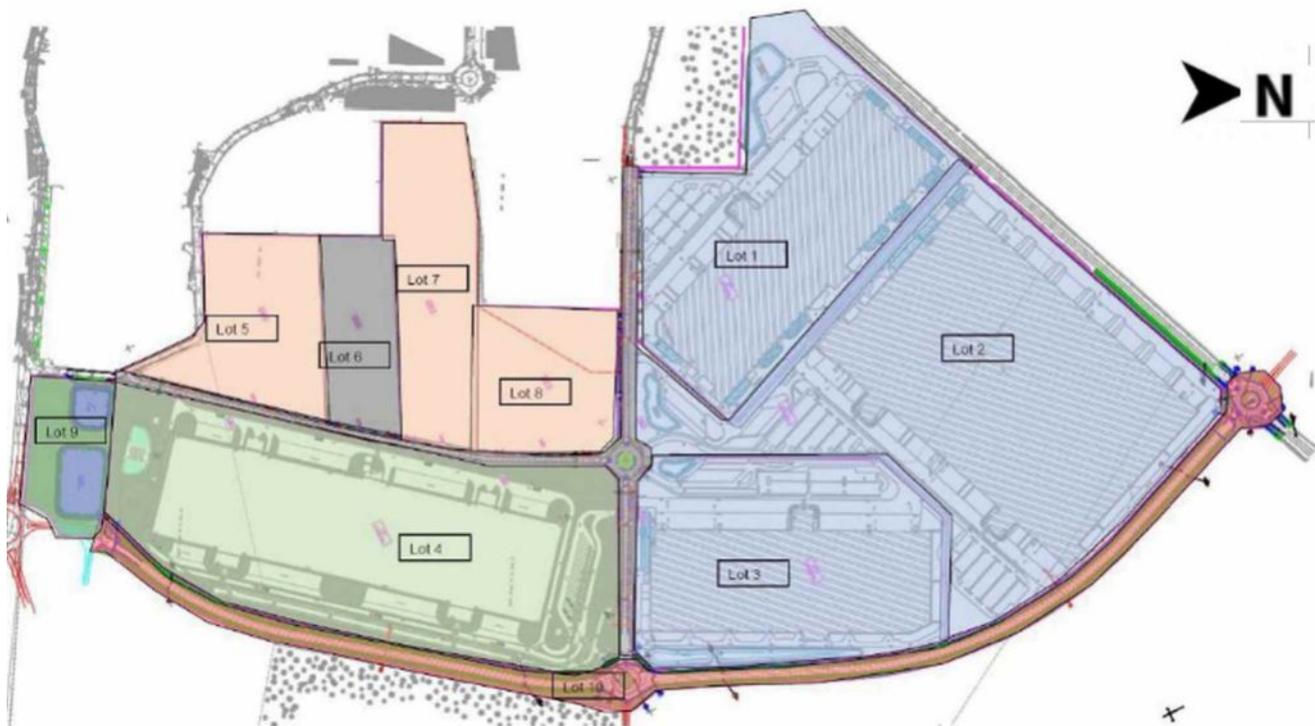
plan masse des différents lots constituant la ZAC « La Chapelle de Guivry » (source : p.15 de l'étude d'impact)
